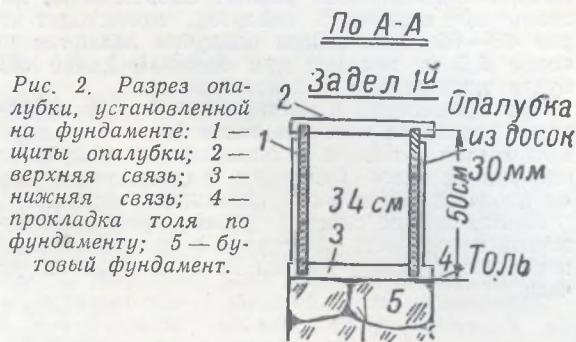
Разрез опалубки, установленной на фундаменте: 1 — щиты опалубки; 2 — верхняя связь; 3 — нижняя связь; 4 — прокладка толя по фундаменту; 5 — бутовый фундамент.
